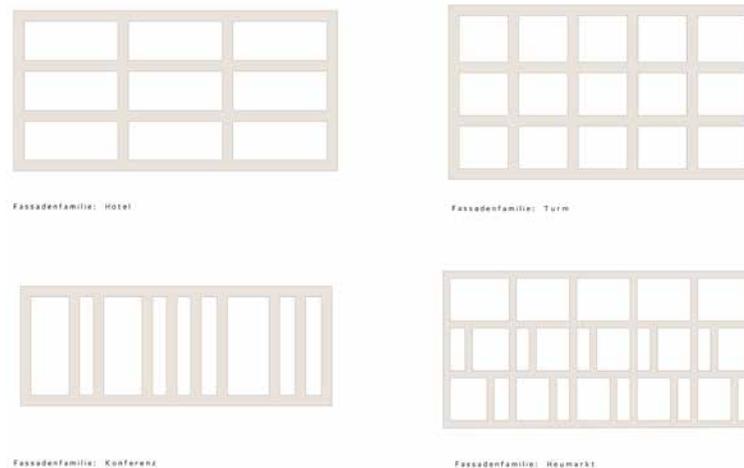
Konzept der unterschiedlichen Fassadenfamilien (© Murr Architekten)
